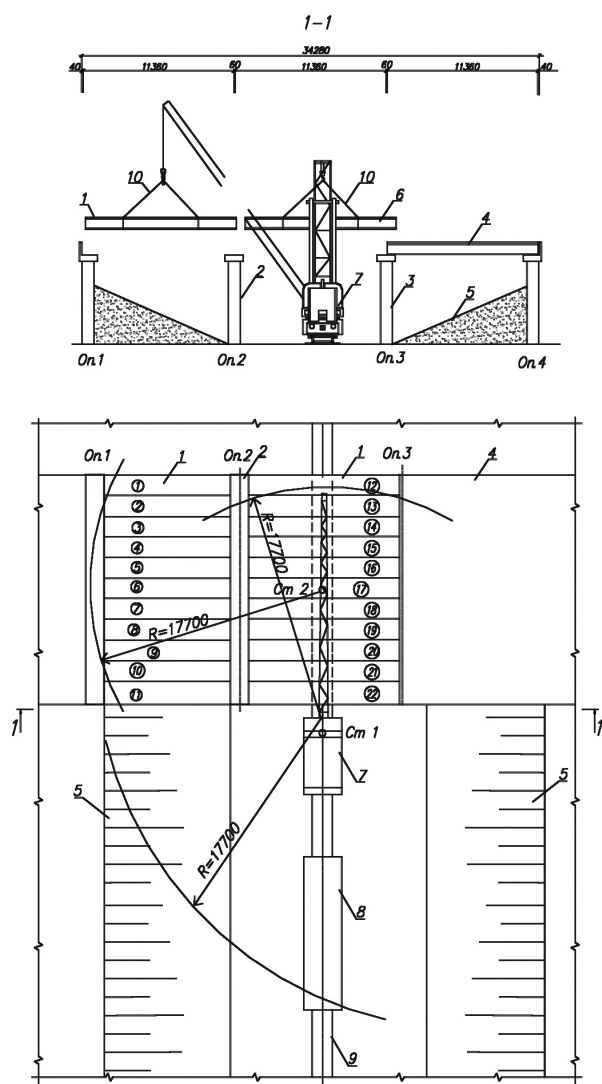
Монтаж балок ПС: 1 – балки пролета 1-2; 2 – опора № 2; 3 – опора № 3; 4 – балки пролета 3-4; 5 – откосы; 6 – монтируемая балка; 7 – кран железнодорожный; 8 – грузовая ж/д платформа; 9 – ж/д пути; 10 – строп; ①-② – порядок демонтажа балок ПС
